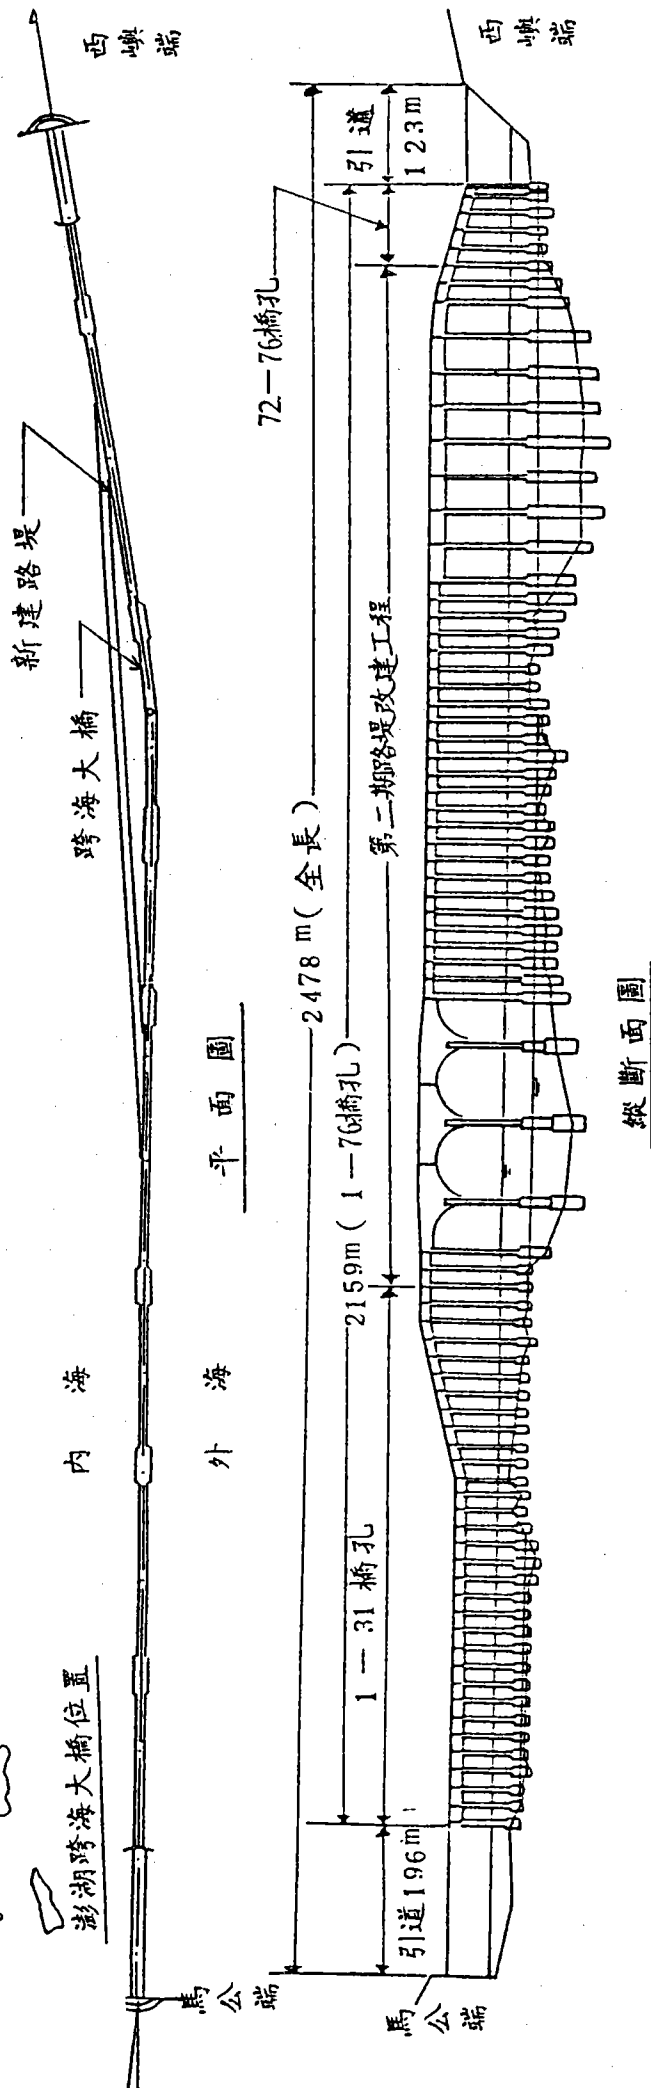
現有澎湖跨海大橋位置、平面及斷面圖
